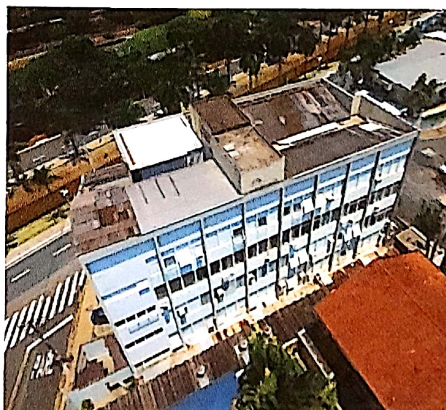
foto aérea, com drone, fachada "dos fundos"
